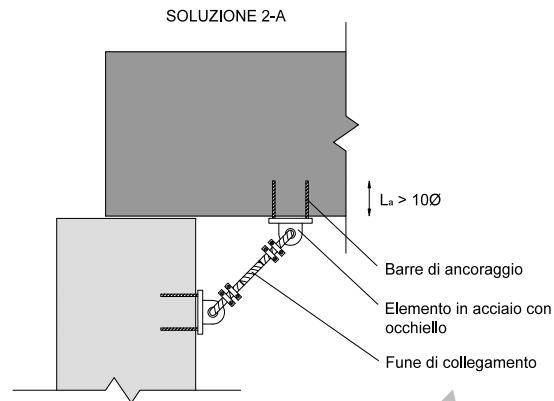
Intervento su connessione trave-pilastro mediante fune di collegamento
